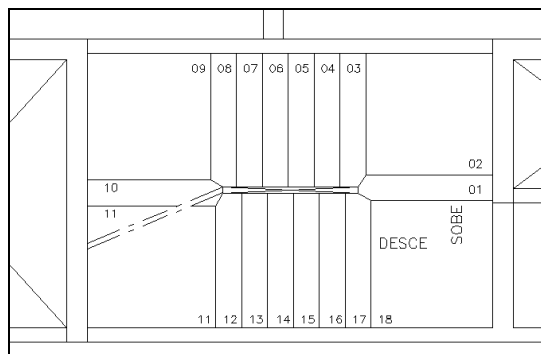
Planta baixa da escada de incêndio - pavimento térreo.
